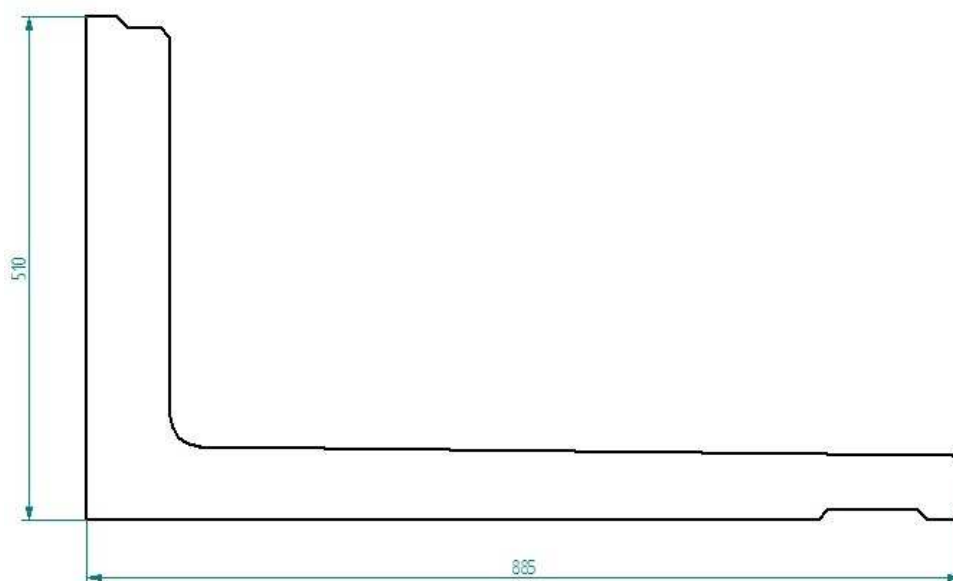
Sección de la viga prefabricada (dimensiones en mm)
